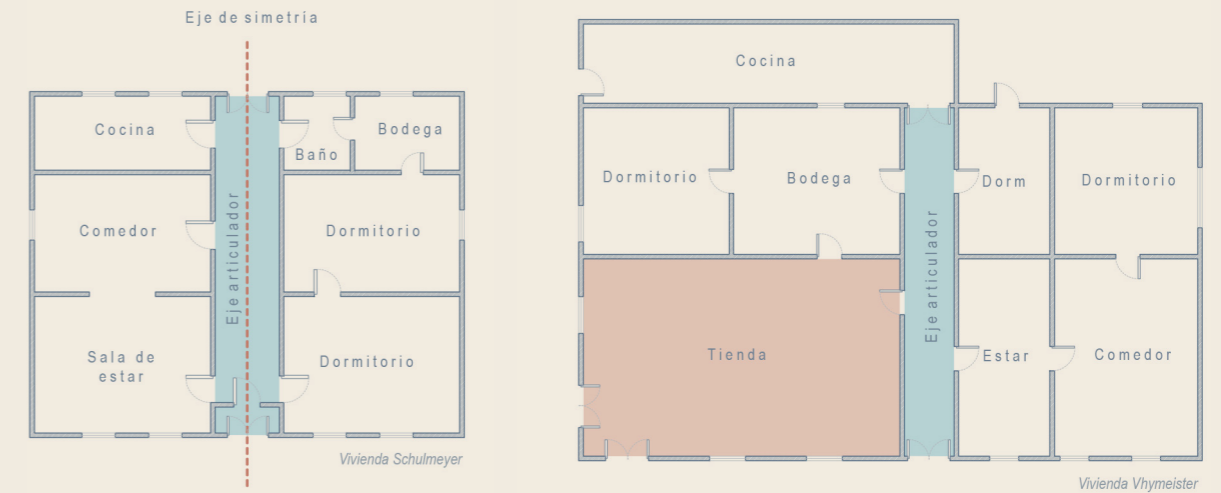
Plantas tipo de las viviendas Schultmeyer y Vhymeister de Contulmo. Fuente: Elaboración propia
